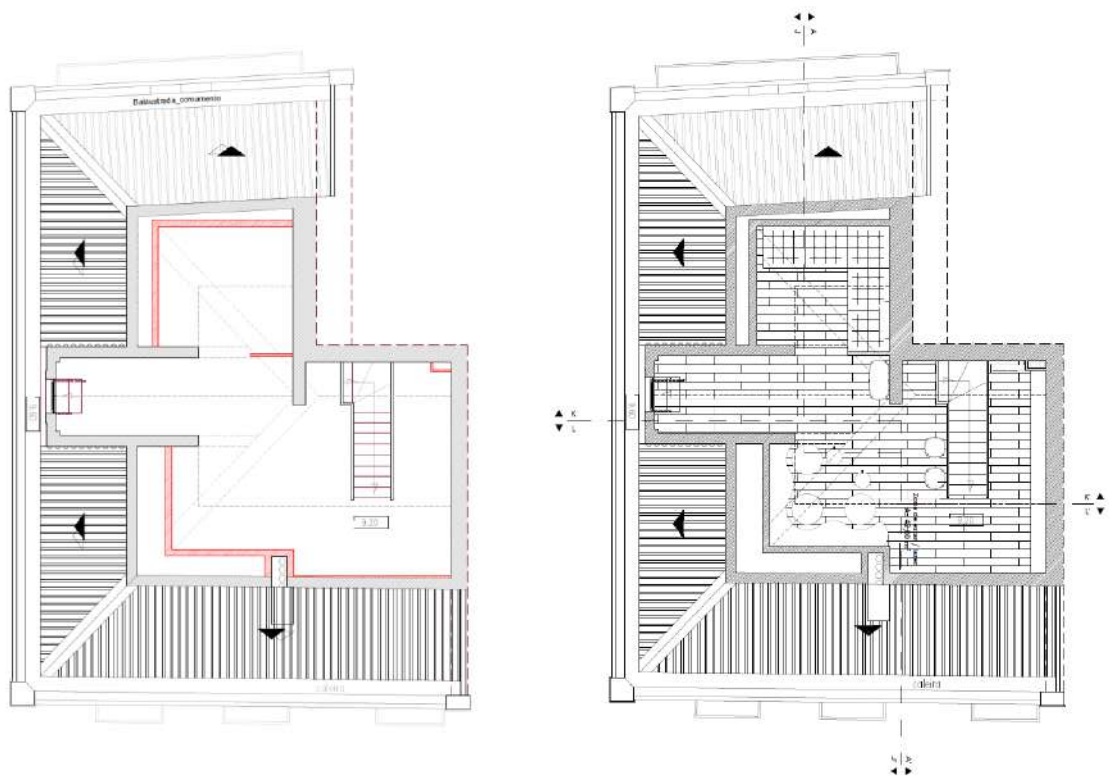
Planta de Alterações e Planta de Apresentação (Piso das Águas-Furtadas)
